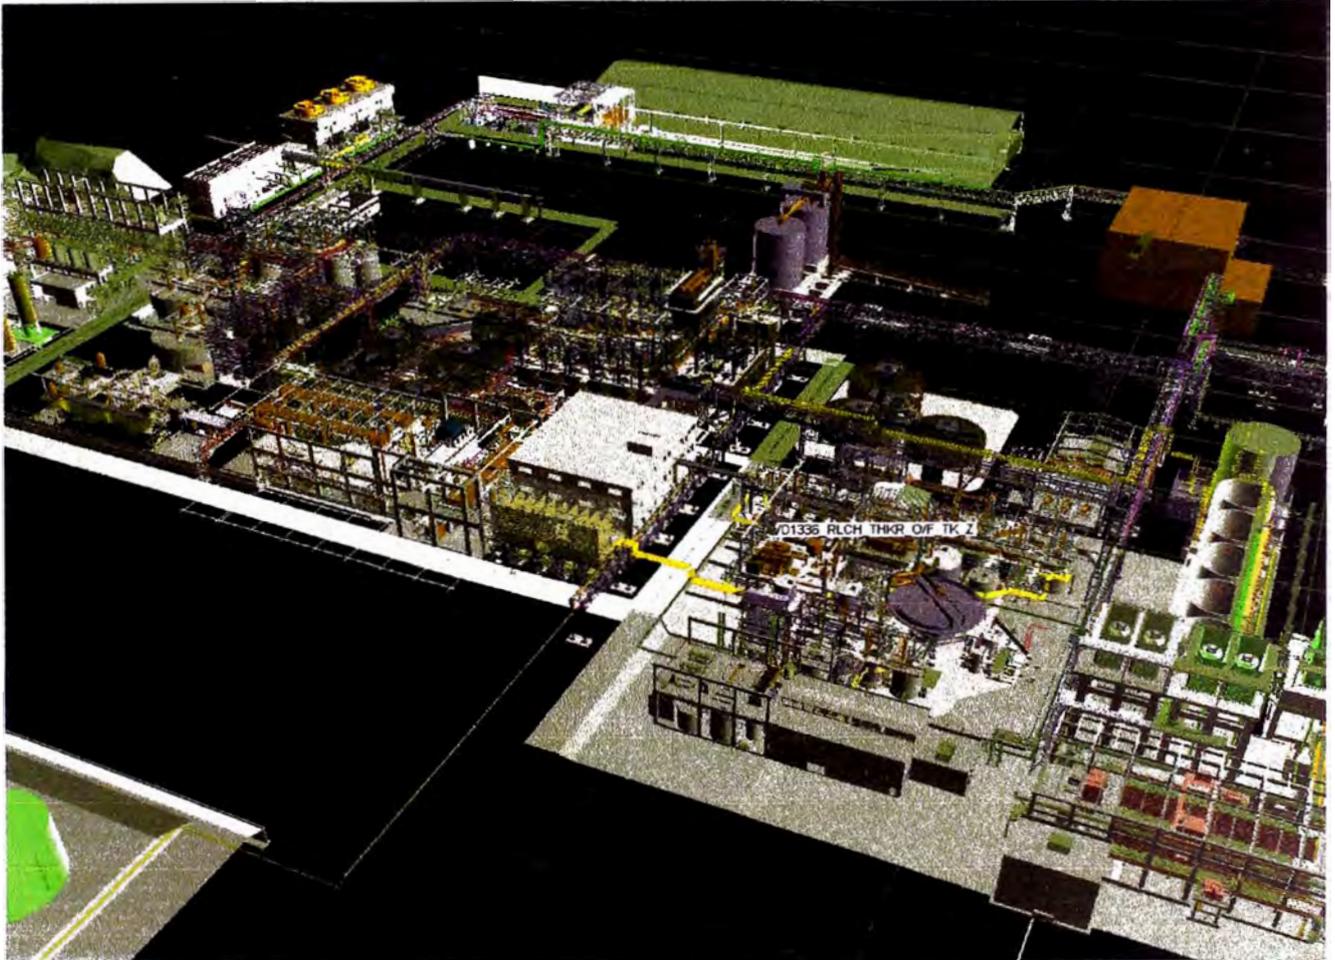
Vista en PDMS de la refinería de Cajamarquilla – Proyecto 320K
